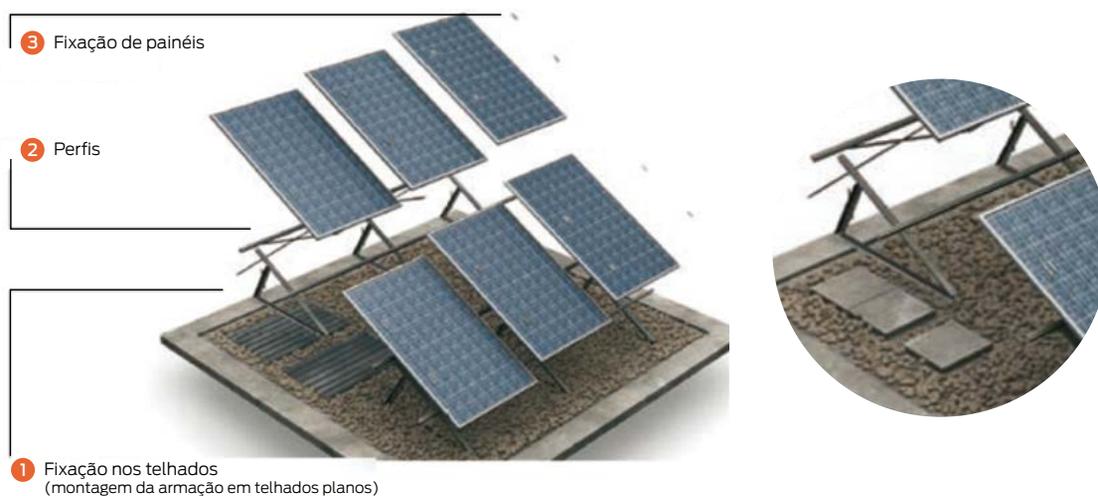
Estruturas em telhados planos / Fonte: (Donauer Solartechnik Vertriebs GmbH, 2009)
